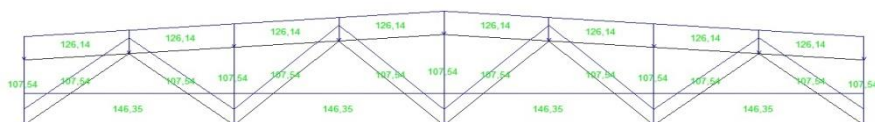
Действие нагрузки от собственного веса фермы
